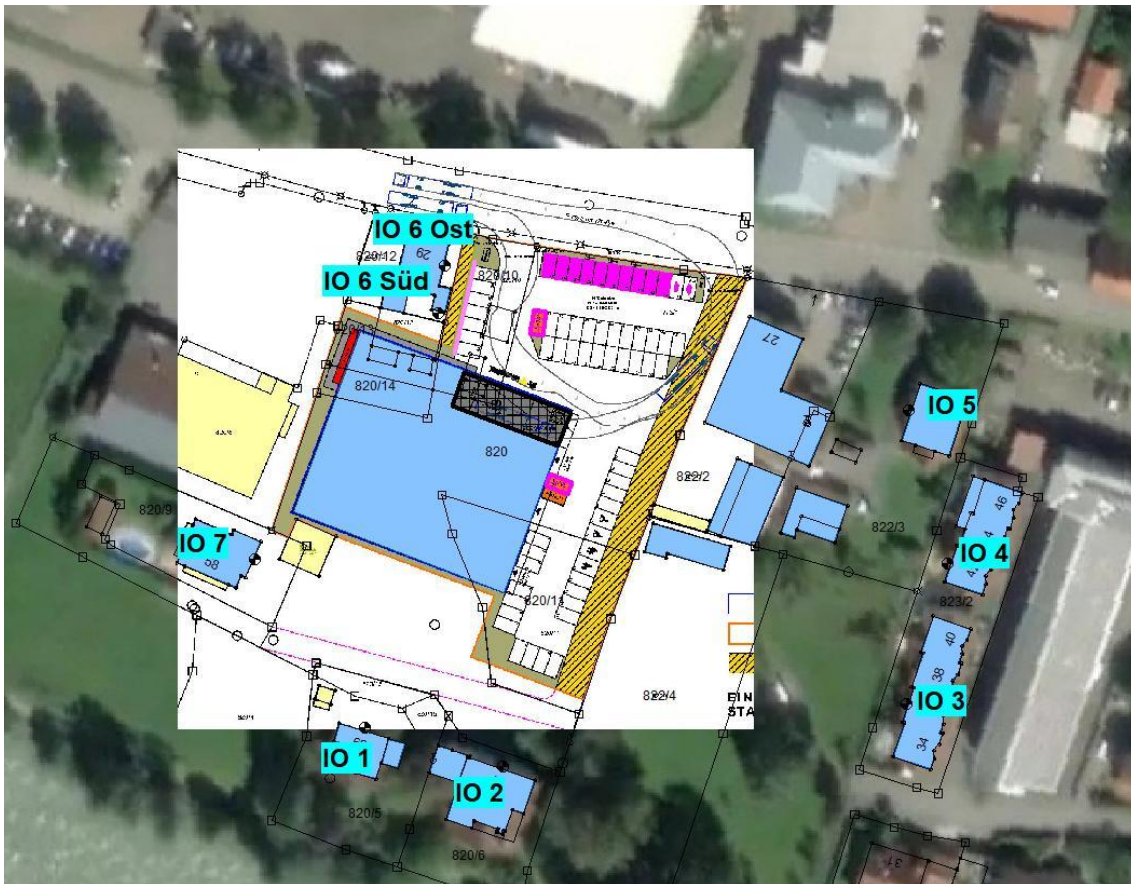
Lageplan mit Kennzeichnung der Immissionsorte IO 1 – IO 7
